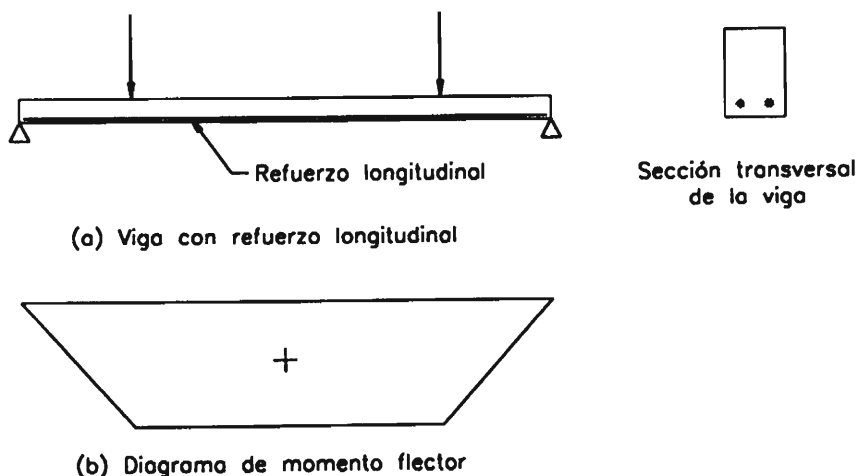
Viga simplemente apoyada sometida a cargas concentradas
